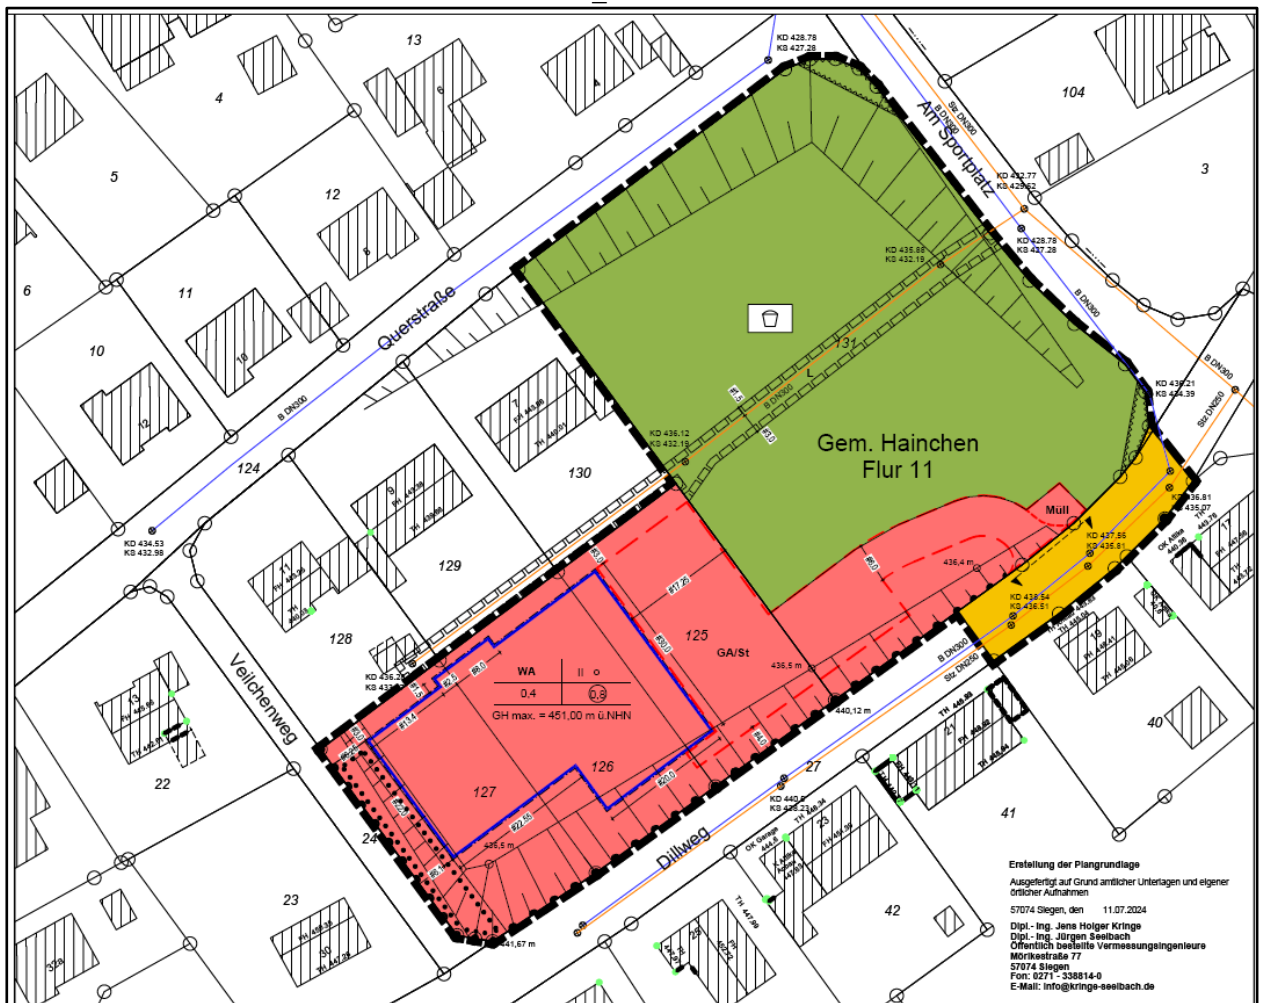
Bebauungsplan Nr. 6, 5. Änderung
